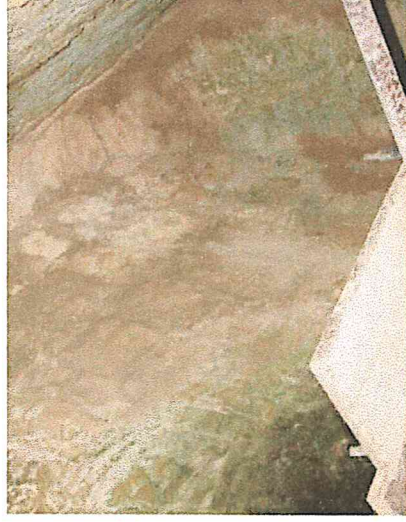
, Vista del muro este de la bóveda de cámara No.11
